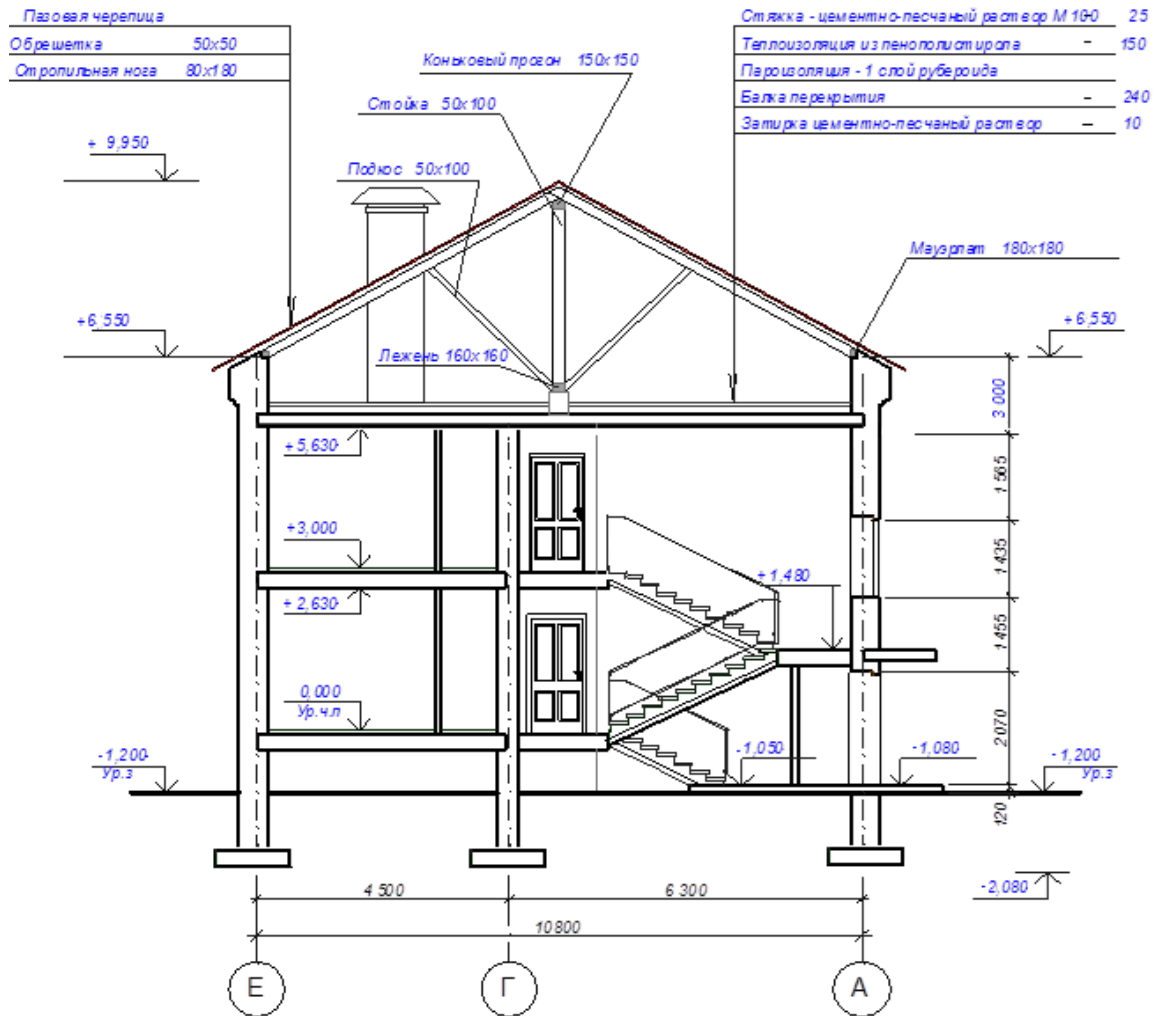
Пример оформления разреза жилого дома со стенами из мелкоформированных элементов
